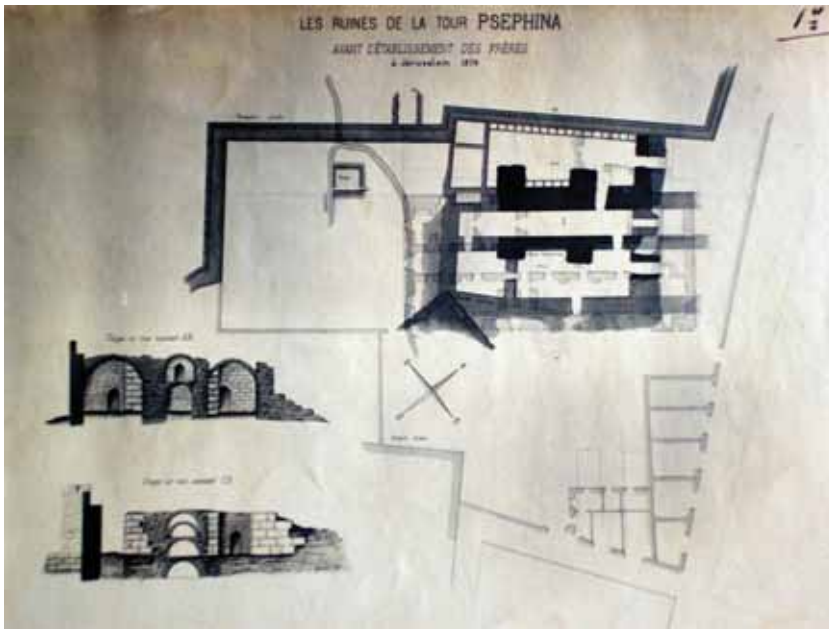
Plan du bâtiment initial, sur les ruines de la tour Psephina (ACJ)
